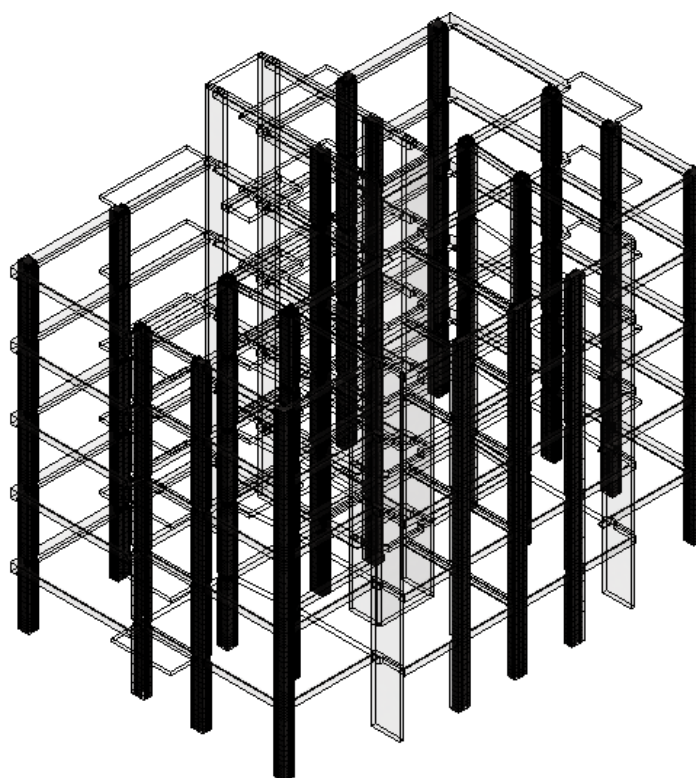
Vista 3D de todos os modelos de armaduras em pilares
